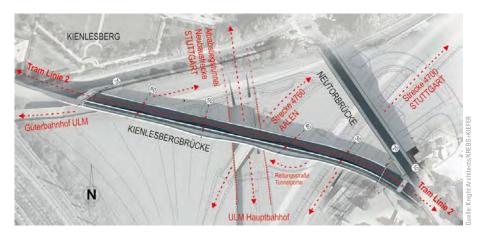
Kienlesbergbrücke: Situationsskizze Kienlesberg bridge: plan view and situation
